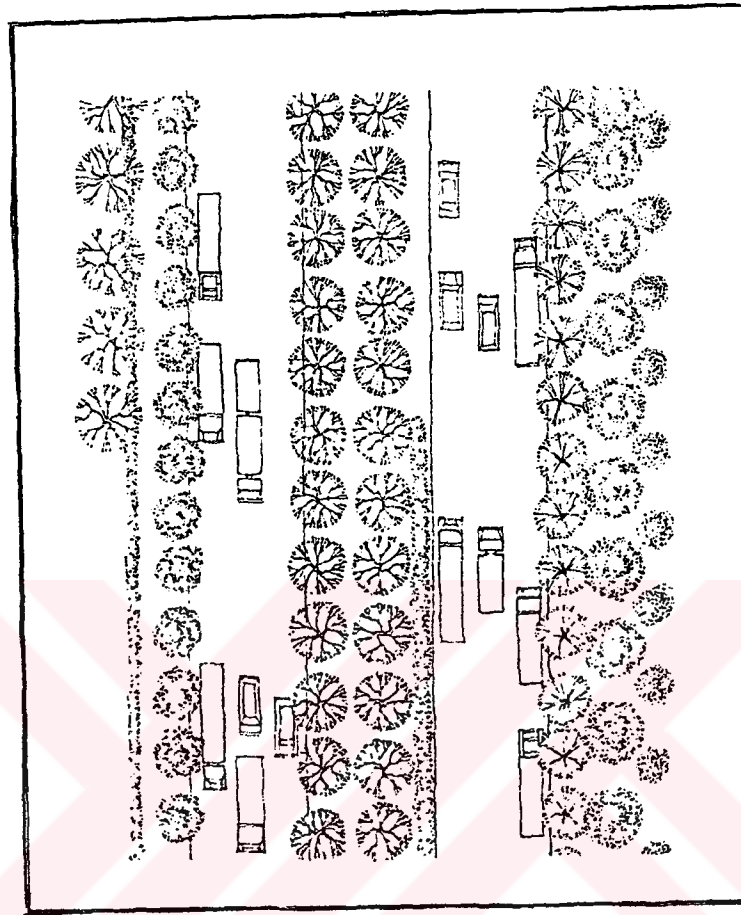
Viale delle Terme di Caracalla Caddesi - Plan (Ölçek: 1/600)
